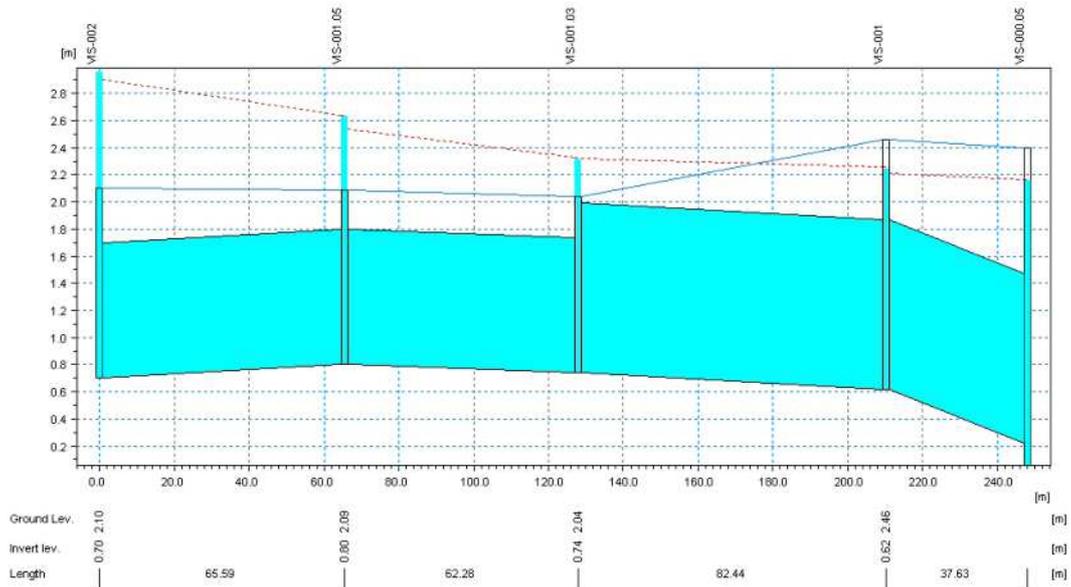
Profilo longitudinale fossa Viserbella
